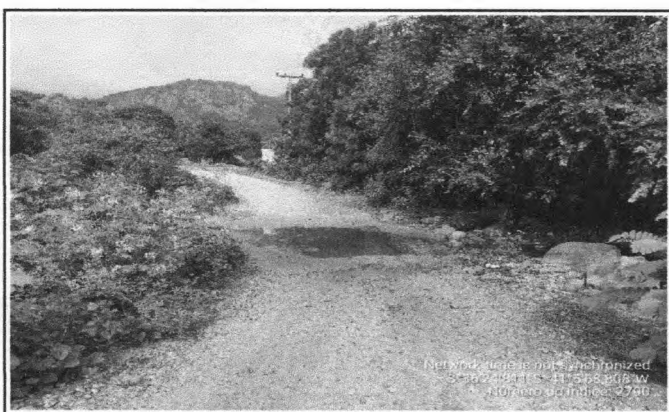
LOCAL DA CONSTRUÇÃO - BUEIRO
